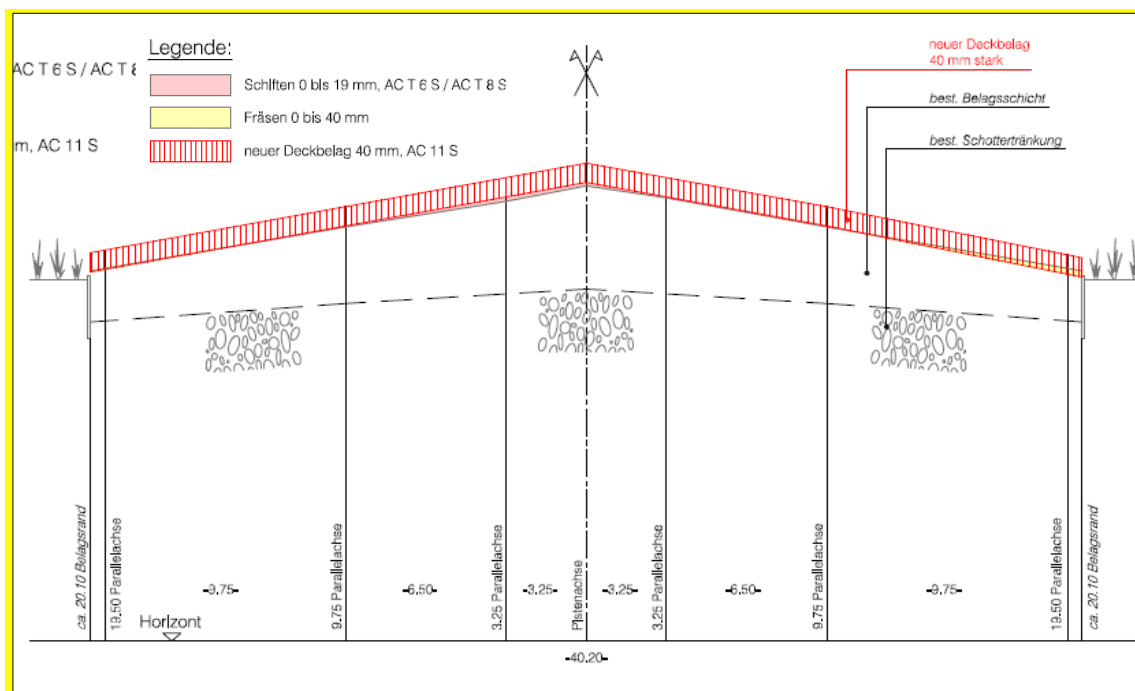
Normalprofil Pistensanierung Meiringen, Variante Hocheinbau
